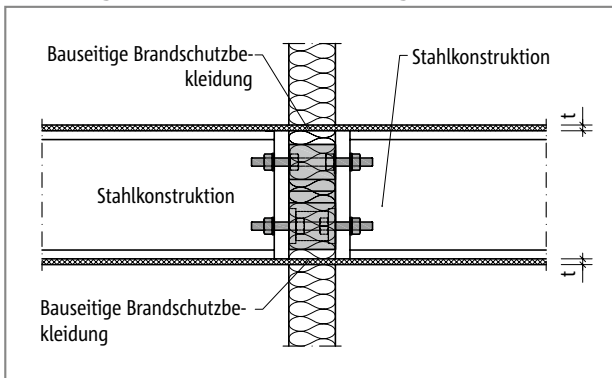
Brandschutz Schöck Isokorb® T Typ S: Bauseitige Brandschutzbekleidung bei bündigen Stirnplatten; Schnitt
